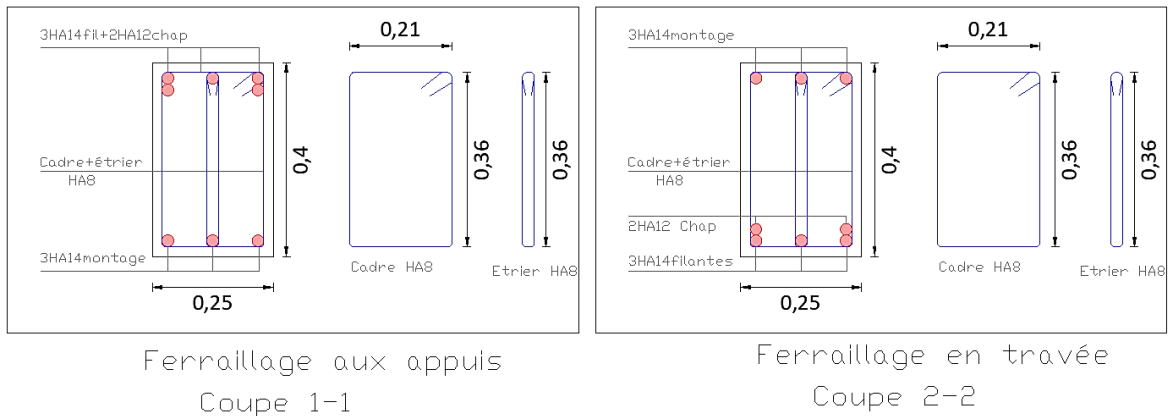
Ferrillage des poutres principales (25x40) cm2
